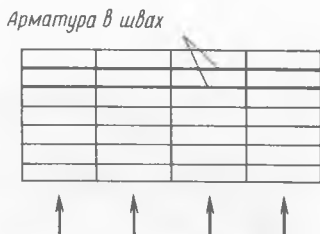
Растянутая арматура в швах для усиления эффекта мембраны из плит покрытия или перекрытия
